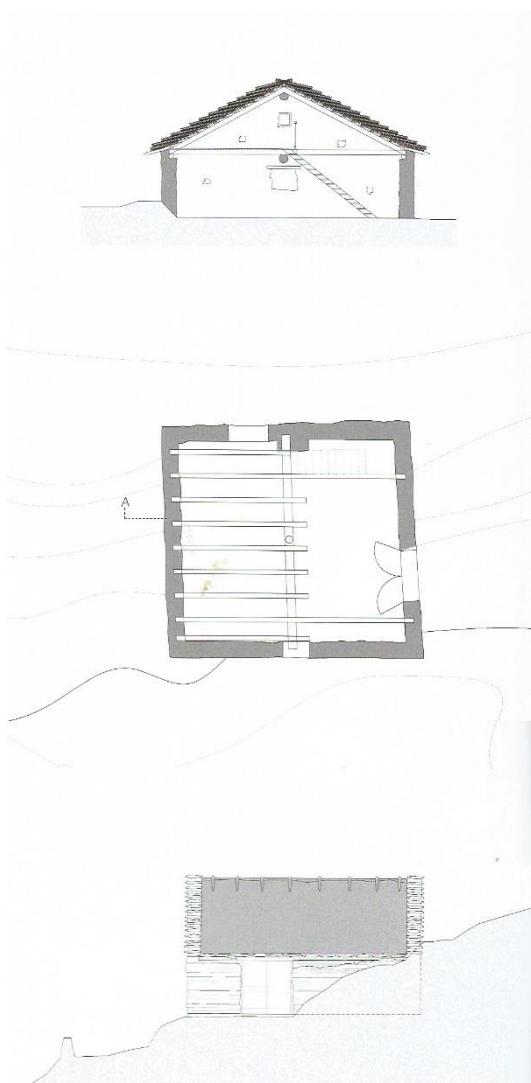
Planta y sección [Libro Josep Bunyesc. Arquitectura Positiva]
